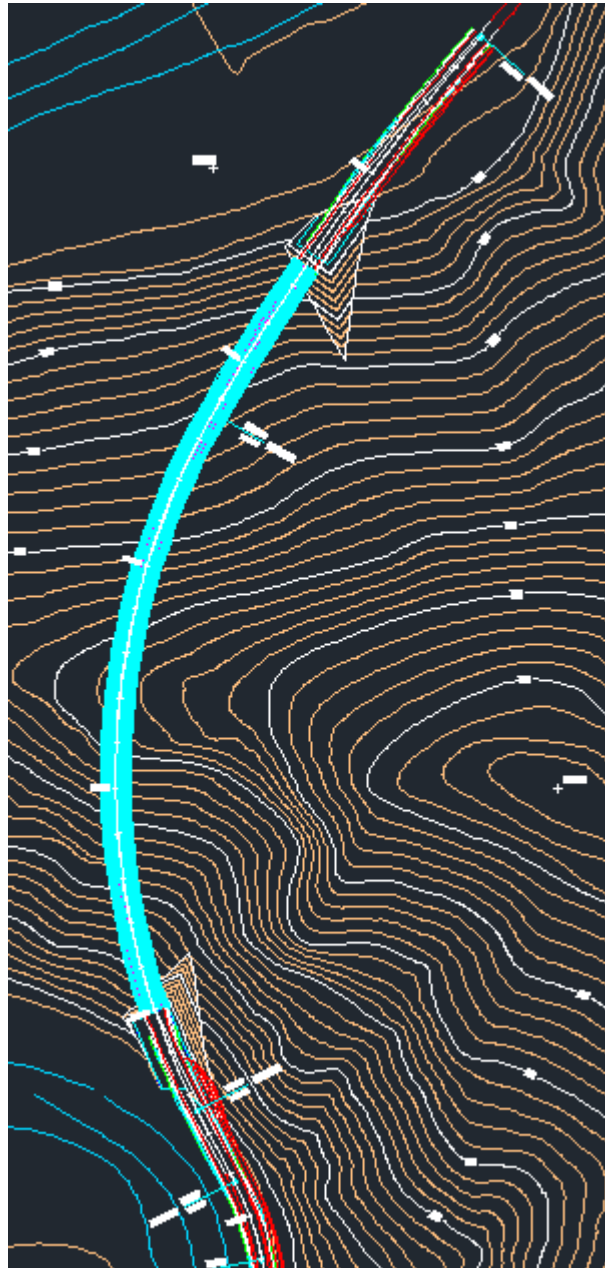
Trazado en planta del túnel. Elaboración Propia
